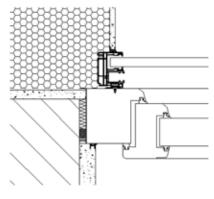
Anschlussdetail mit Führungsschiene AK-FLEX
